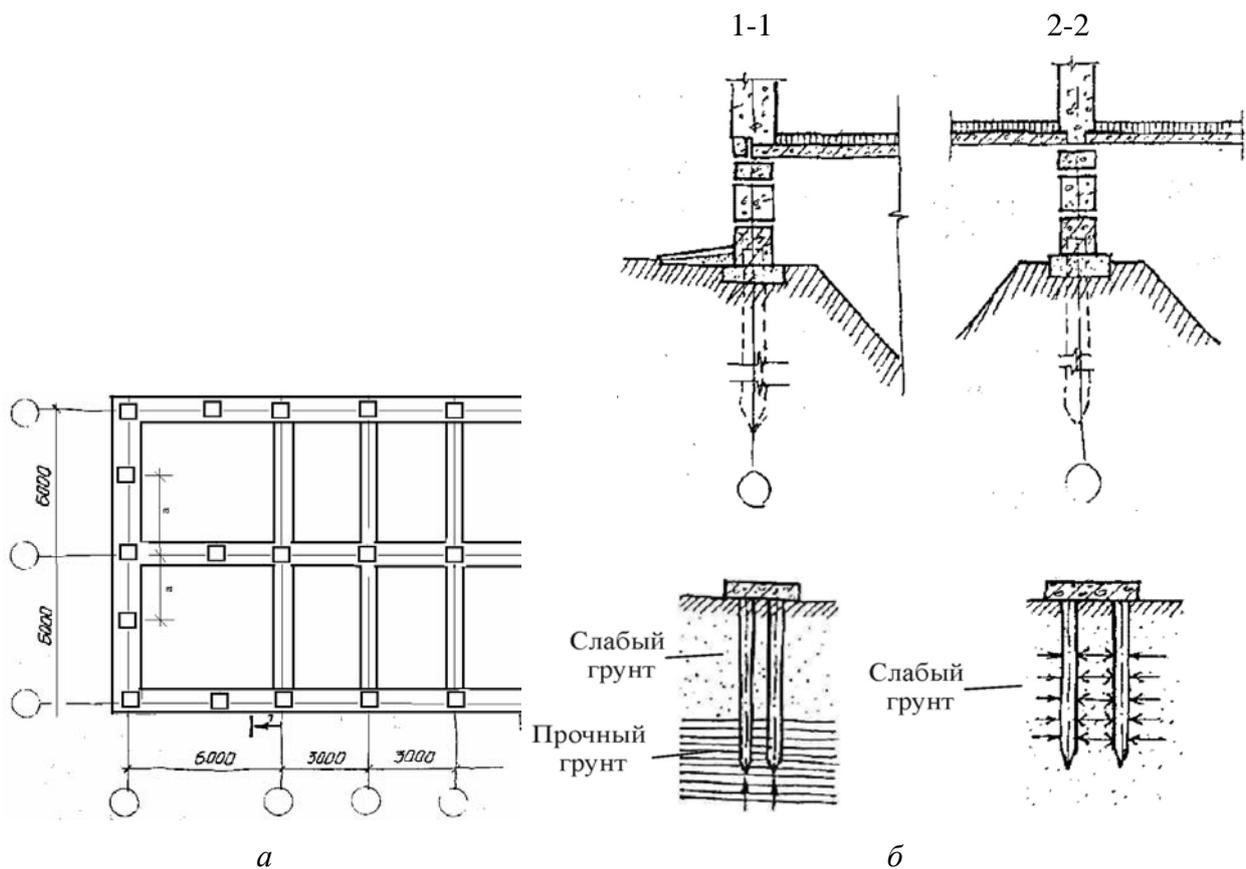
Детализация свайного фундамента: *а* — свайный фундамент; *б* — разрезы
